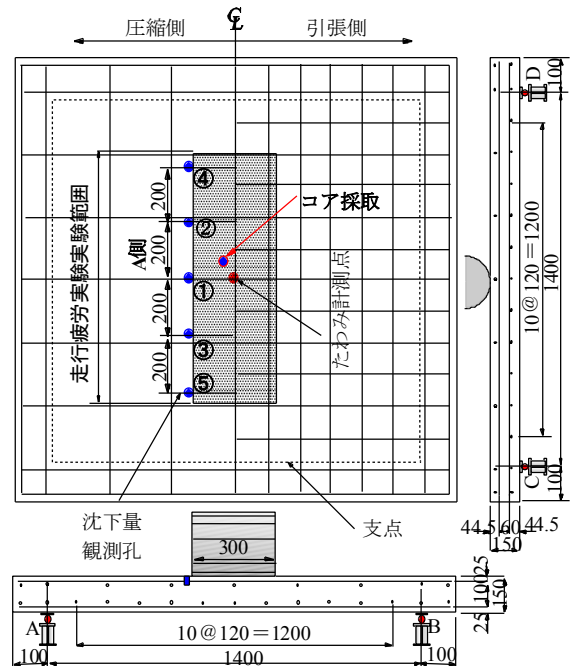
供試体寸法および水平ひび割れ計測位置
